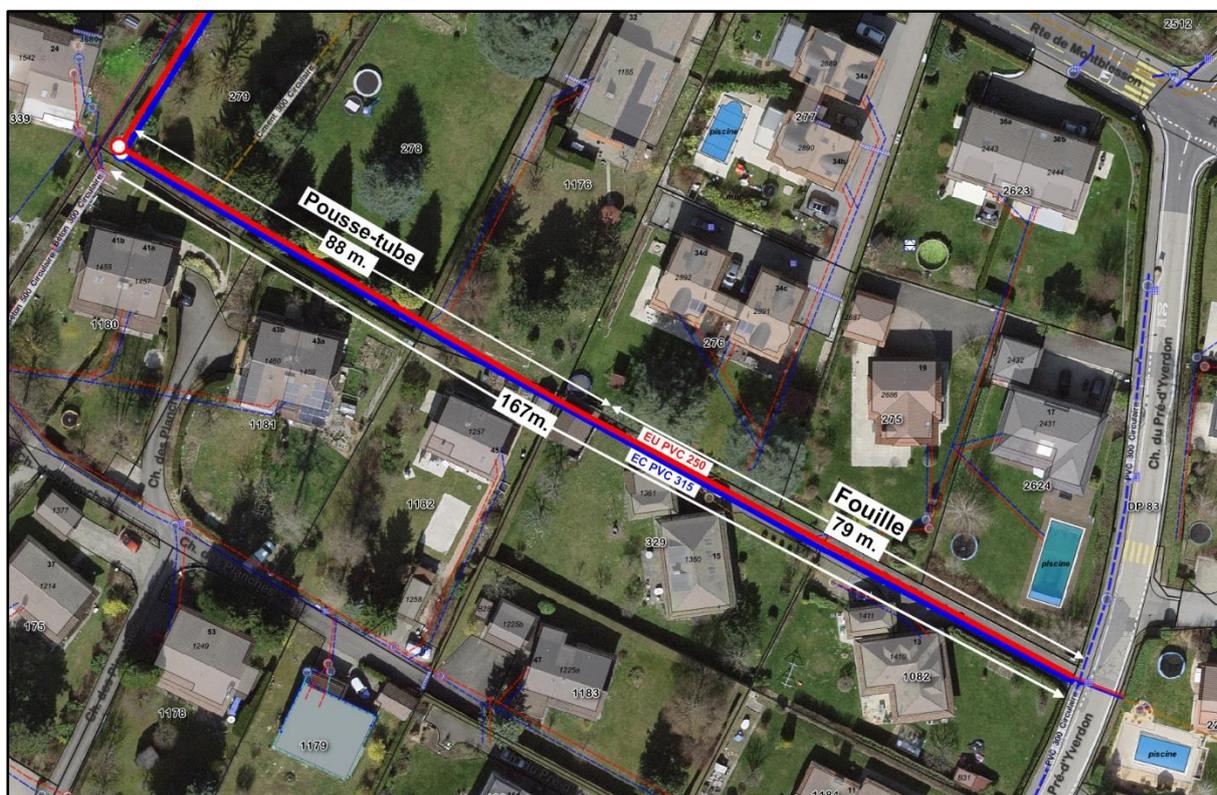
Plan des futurs collecteurs en séparatif (88m. en pousse-tube et 79m. en fouille)
